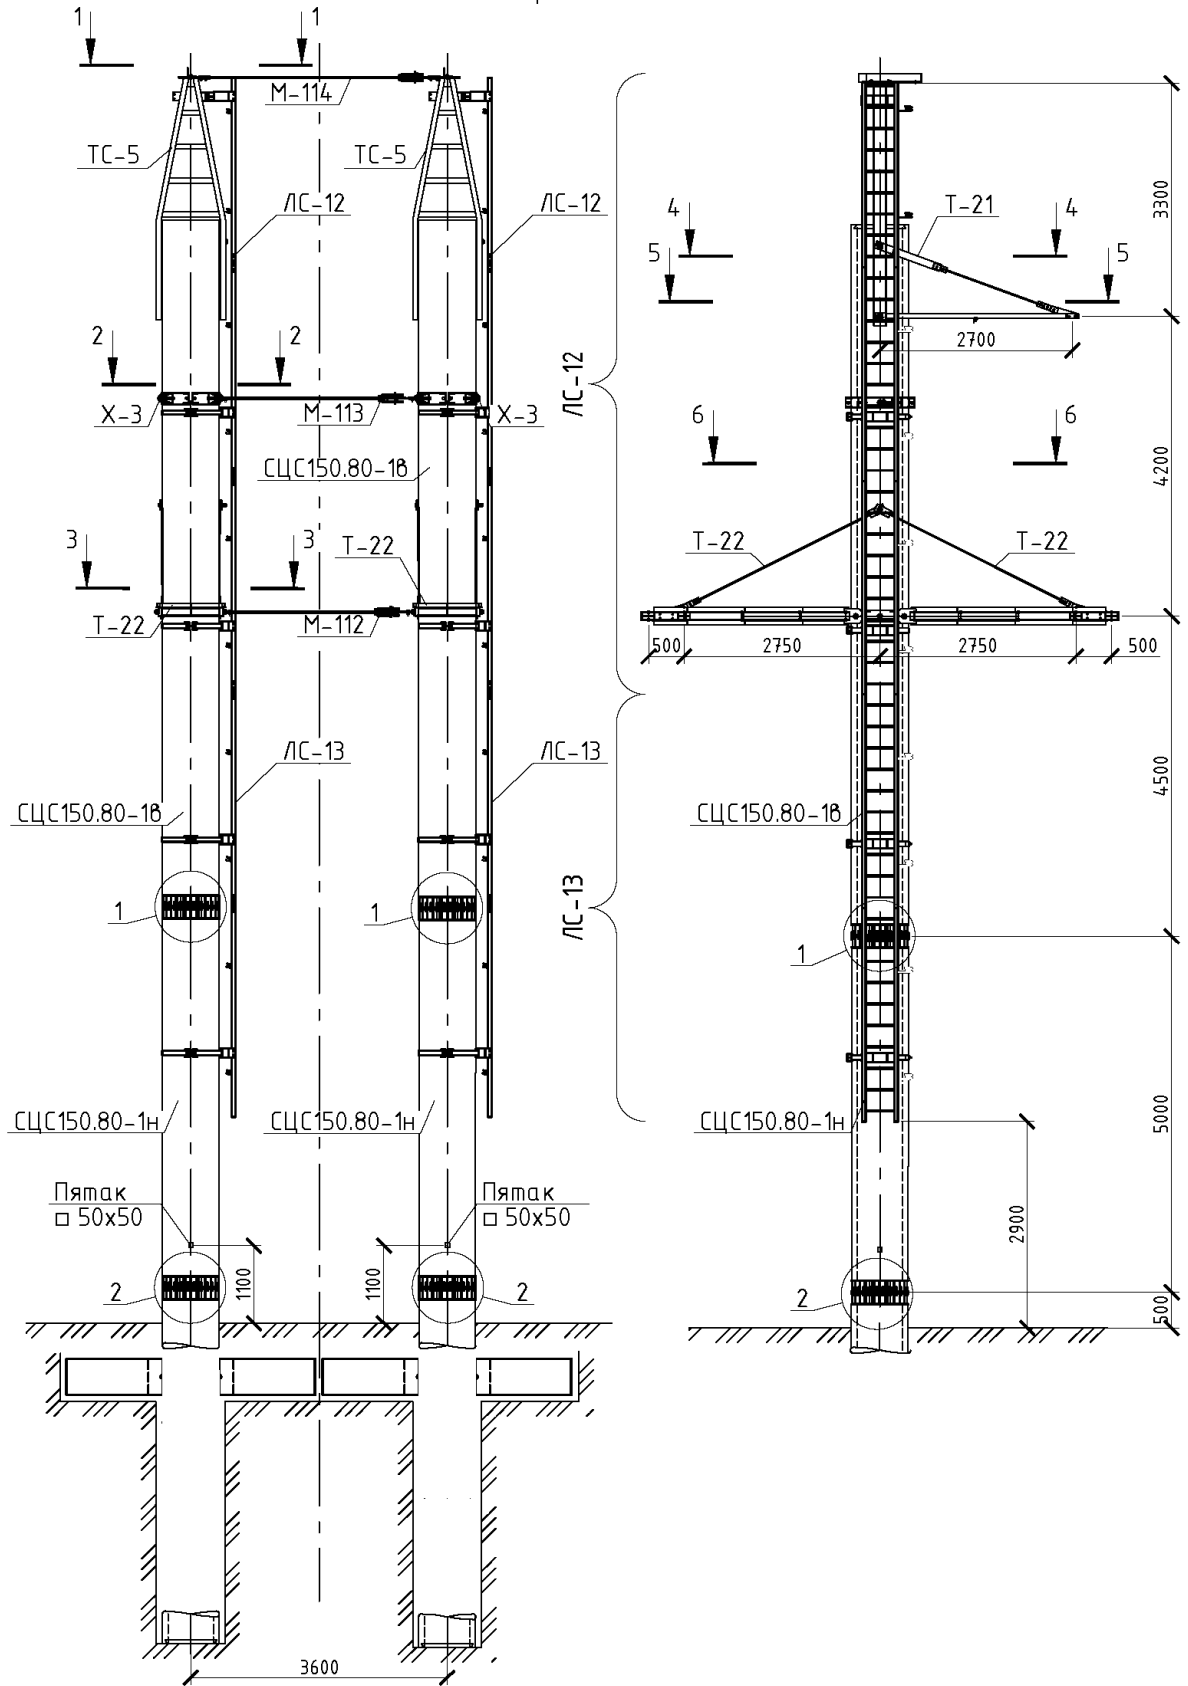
Общий вид промежуточной опоры 2СУБ110-1Ф.
